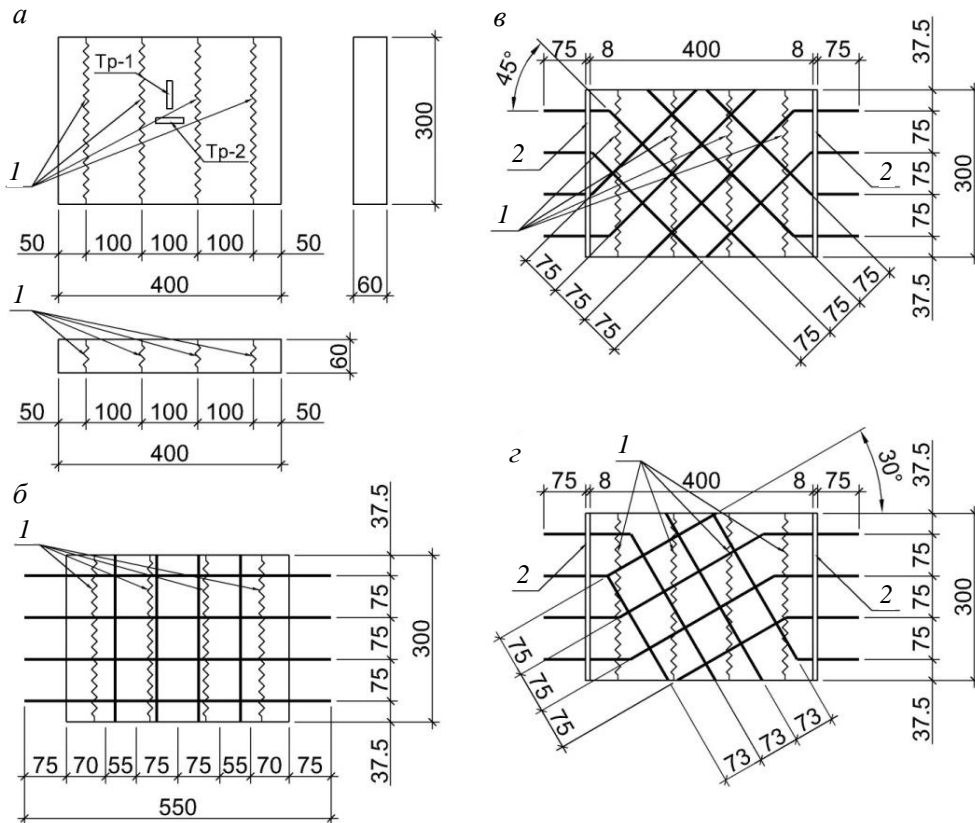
Общий вид образцов и расстановка тензодатчиков на бетоне (а) и схемы армирования образцов при различных углах наклона арматурных стержней к трещинам (б, в, г):
